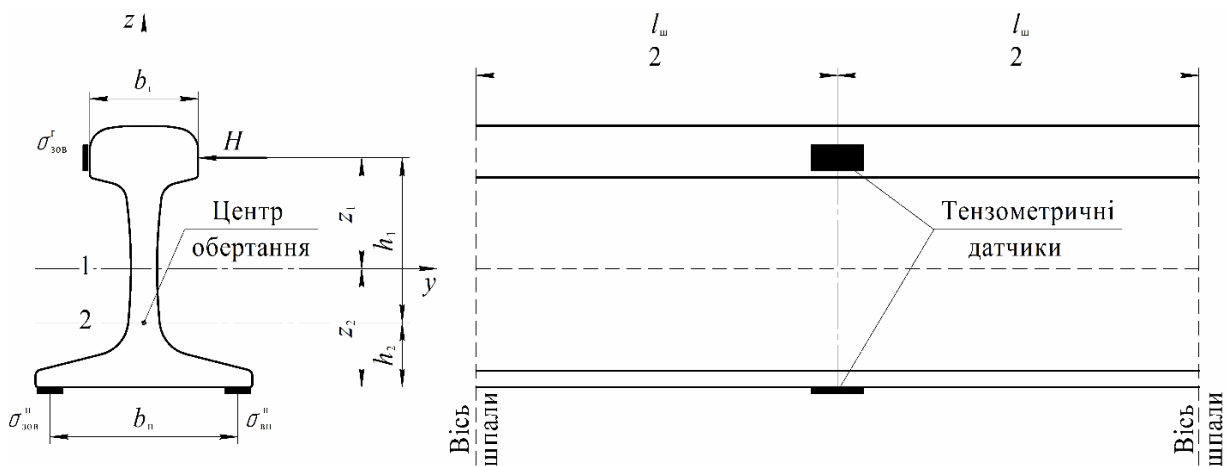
Схема вимірювання напружень в кромках підшви і зовнішній кромці головки рейки:
